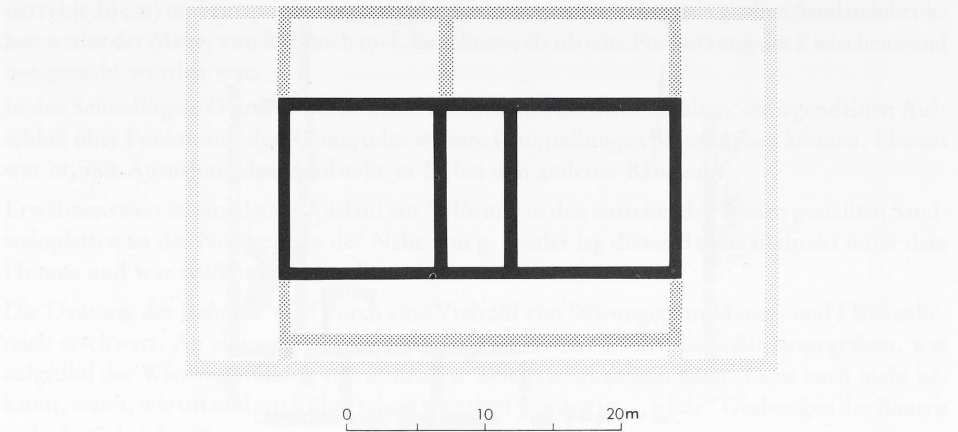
Fischbach, Gde. Niedereschach, Schwarzwald-Baar-Kreis, Gewann „Bubenholz“; Gebäude II (Hauptgebäude). Plan mit Eintragung der verschiedenen Bauphasen.
